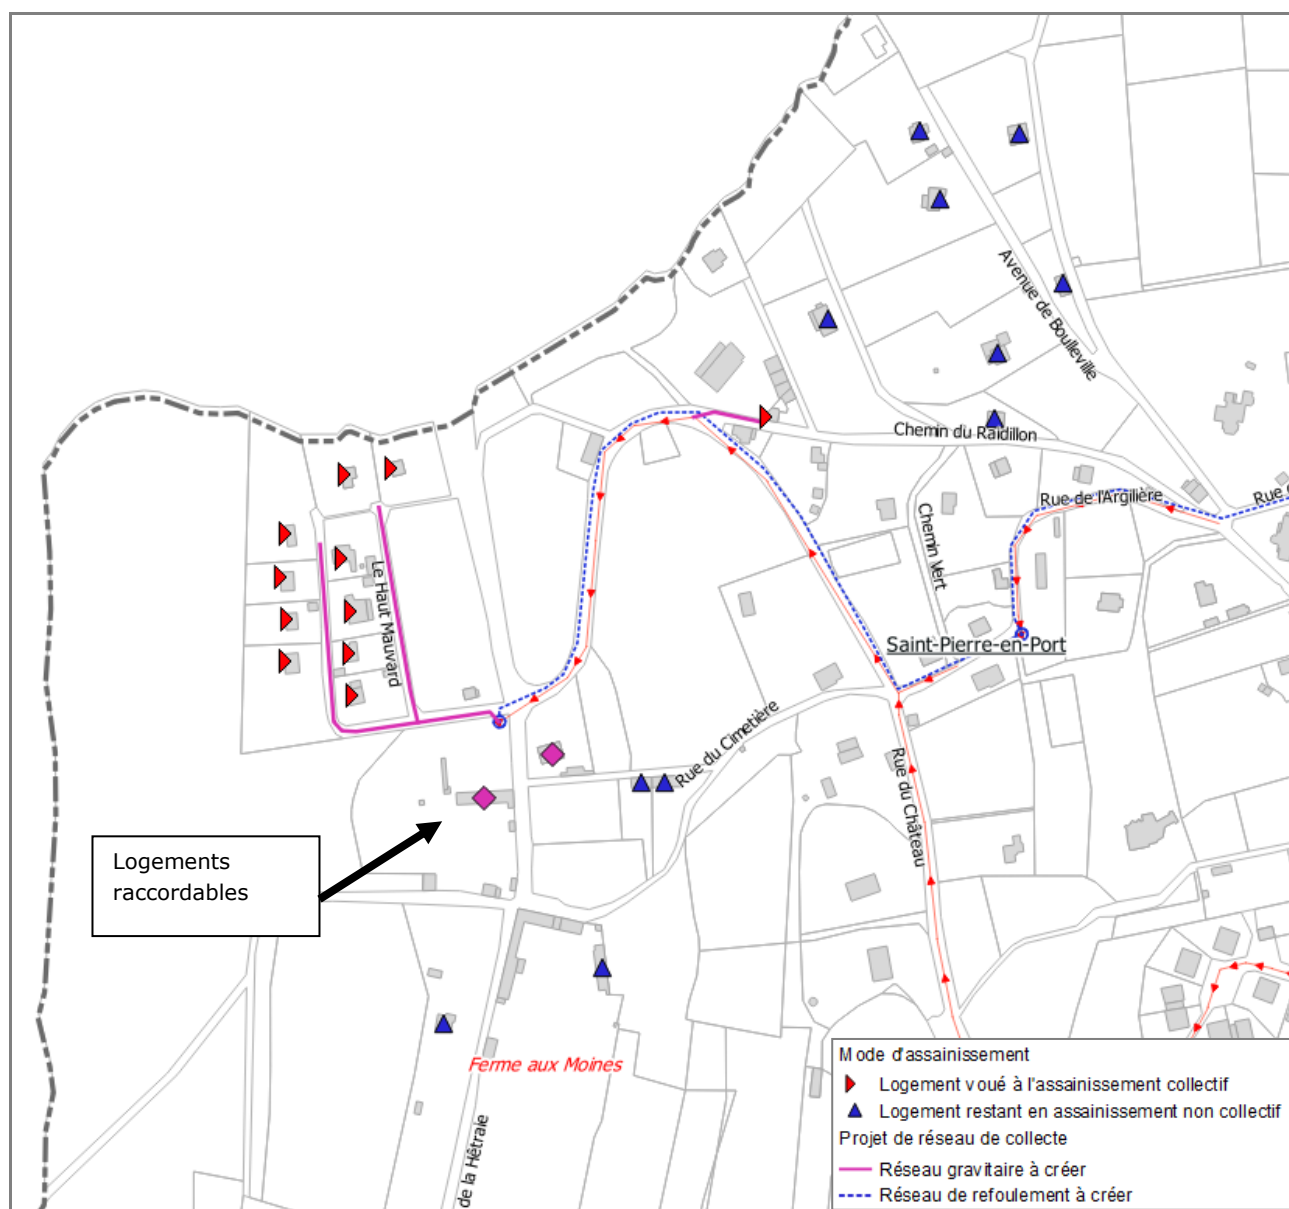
Projet de raccordement – Secteur chemin du Haut Mauvard - St Pierre en Port
